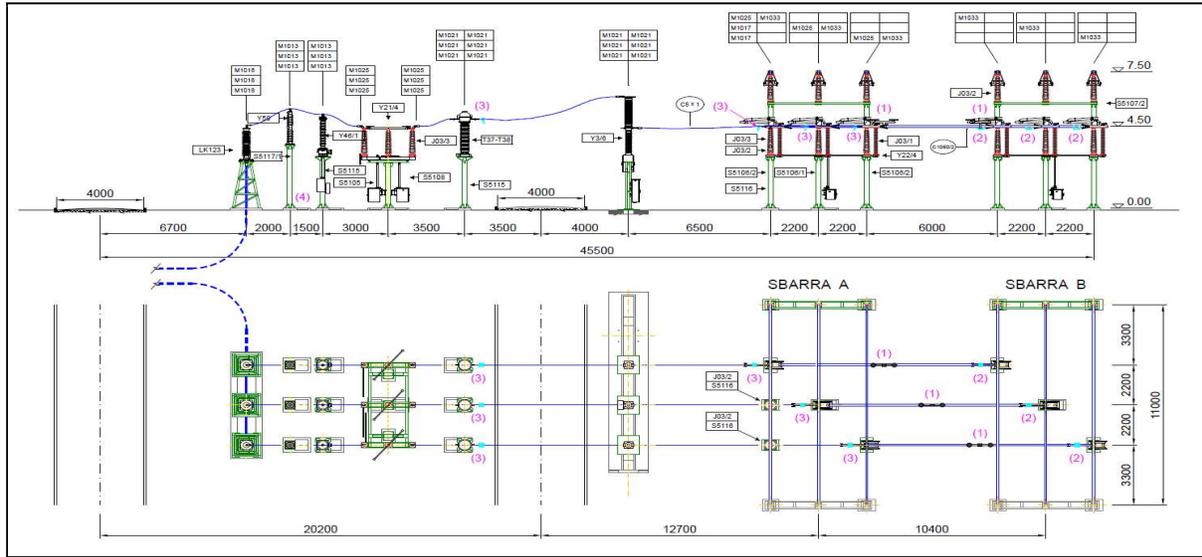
Planimetria e sezione elettromeccanica relativa alle apparecchiature dello stallone 150 kV nella stazione Terna
